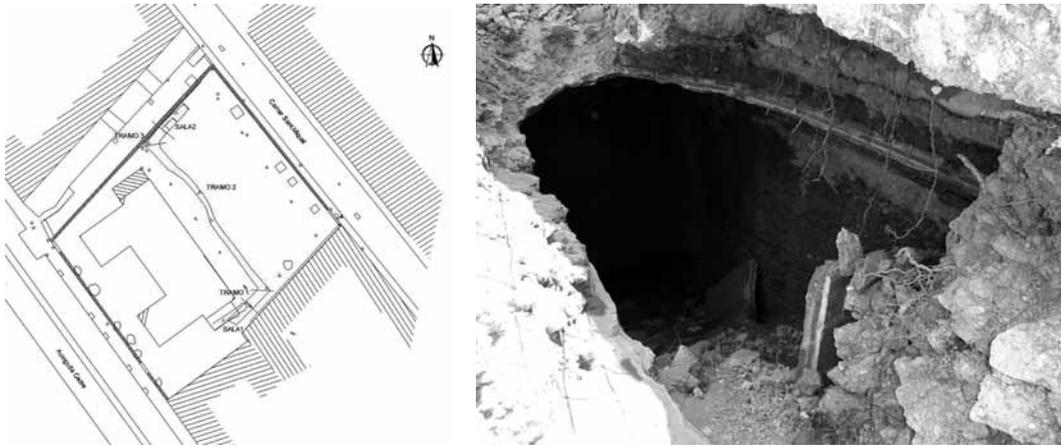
Levantamiento de la planta del refugio realizado por Global Mediterránea en junio de 2010
